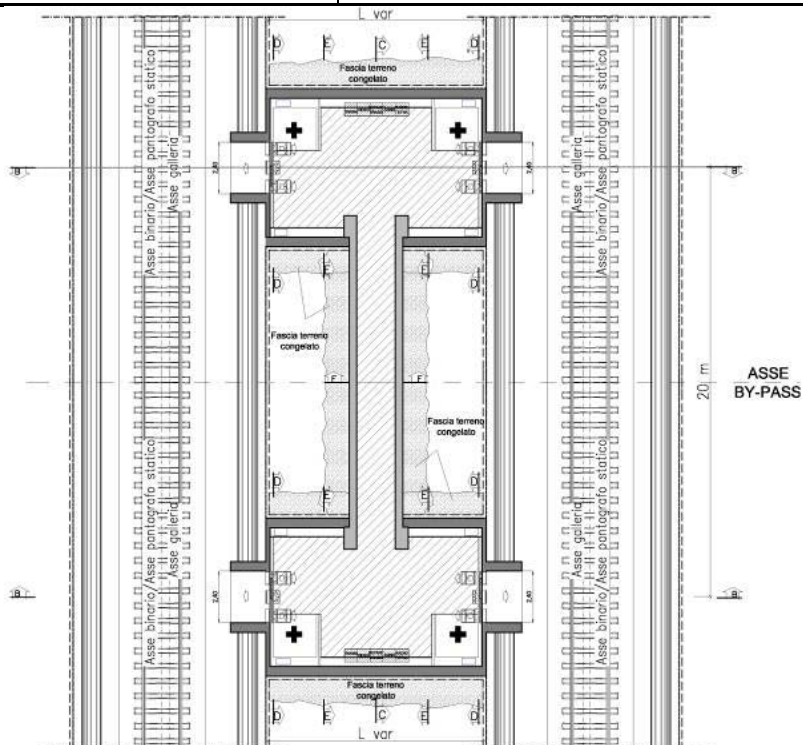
Sezione e pianta dei cunicoli di by-pass.
